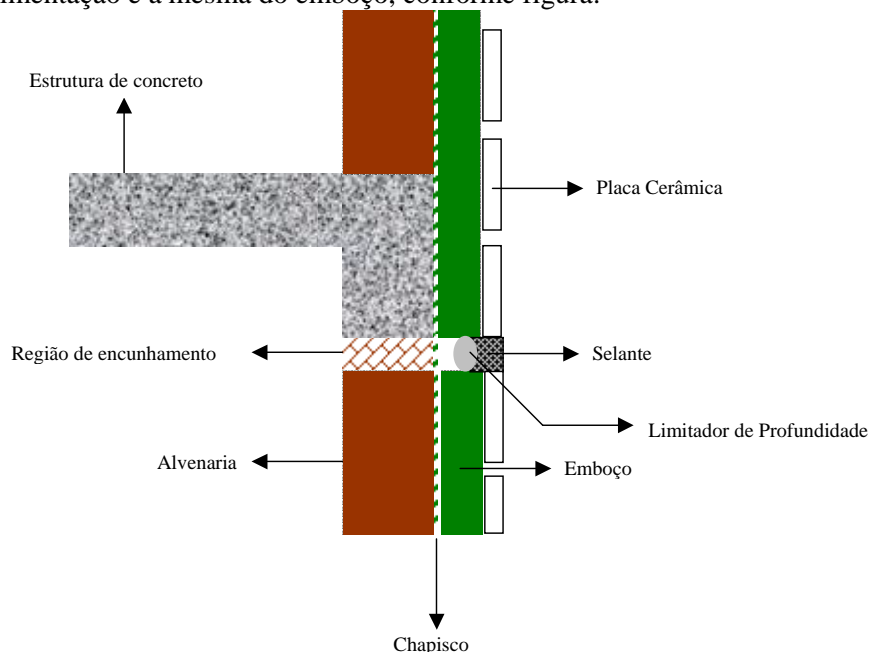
Detalhe de execução da junta de movimentação da fachada.
